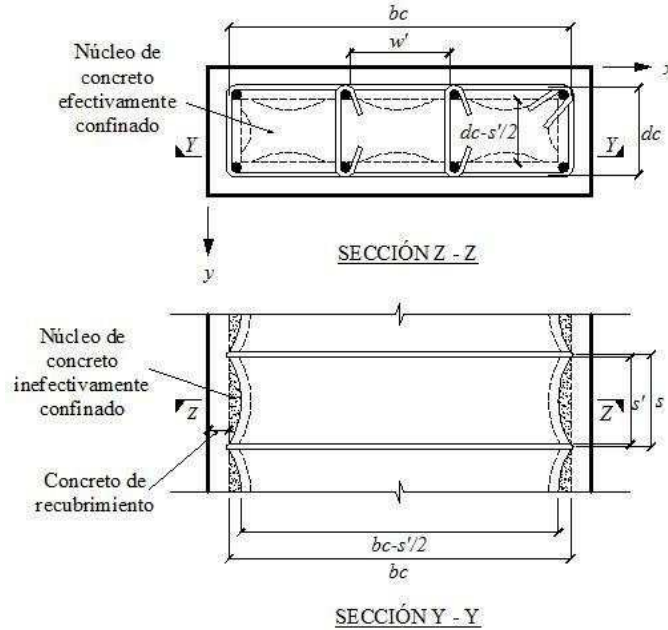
Confinamiento efectivo del núcleo de concreto para secciones reforzadas con estribos rectangulares propuesto en el modelo de J. B. Mander, M. J. N. Priestley y R. Park
